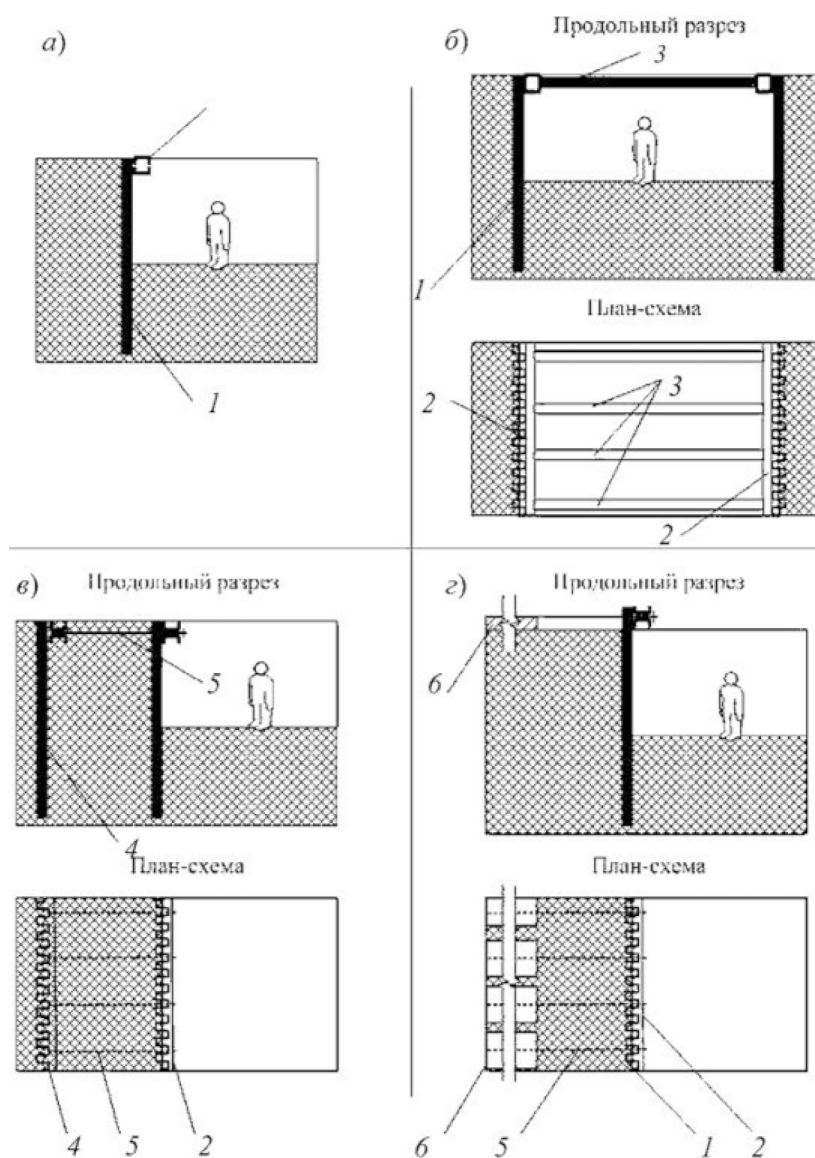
Конструктивно-технологические решения по обеспечению устойчивости шпунтовых ограждений: *а* – консольное; *б* – с горизонтальными креплениями стальными балками; *в* – с анкерными стенками из шпунта; *г* – с горизонтальными анкерными плитами; *1* – шпунтовое ограждение; *2* – распределительный пояс (обвязочная балка); *3* – горизонтальные стальные балки; *4* – анкерная стенка из шпунта; *5* – стальные анкерные тяги; *6* – анкерные плиты, уложенные по кругу
